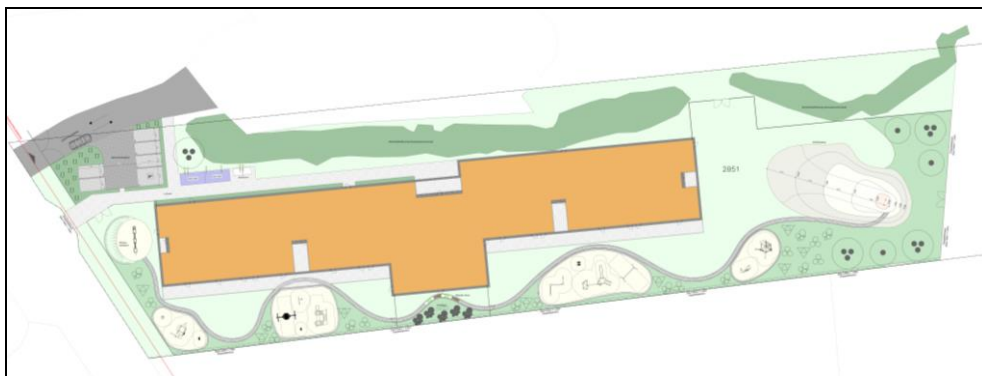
Lageplan Kindertagesstätte, © projektbüro 678
